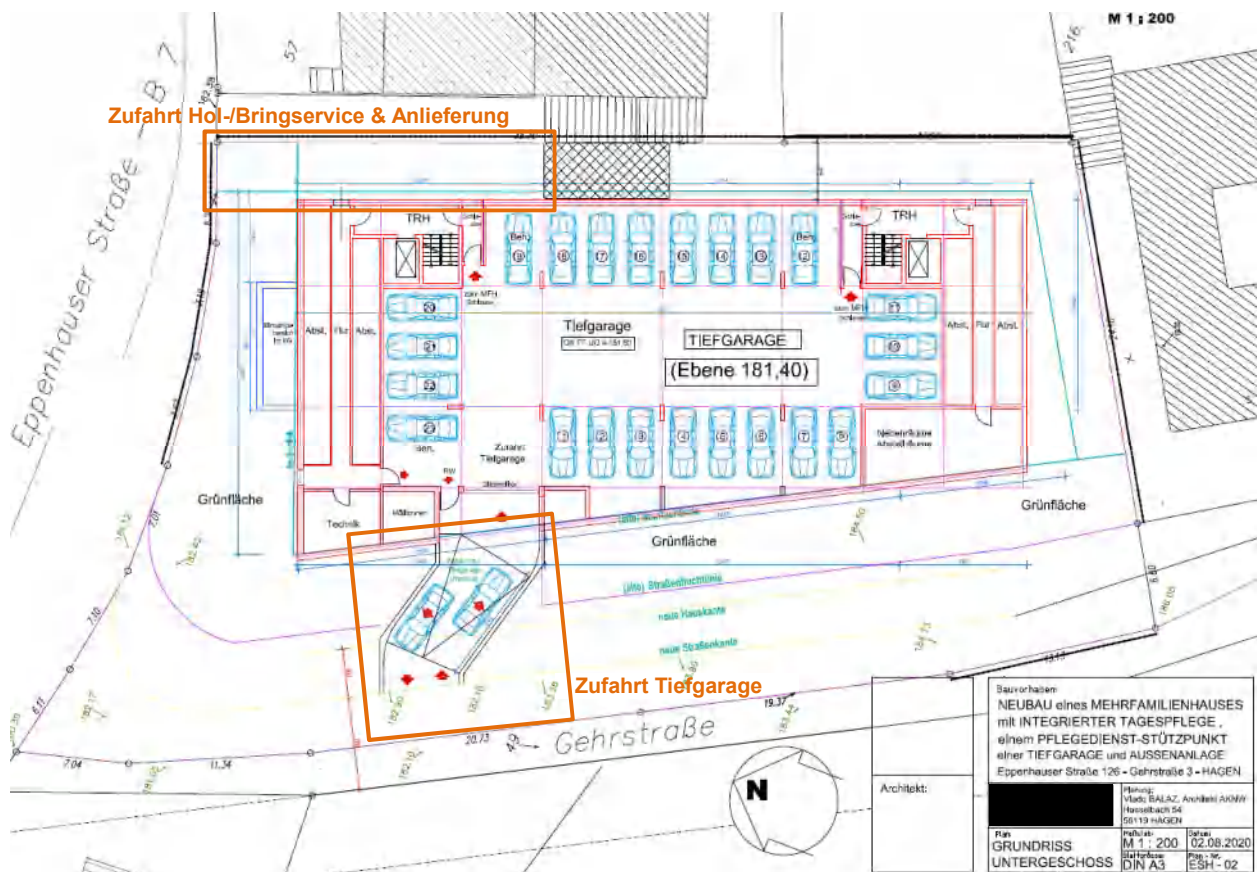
Geplante Erschließung des Plangrundstücks mit Zufahrt zur Tiefgarage über die Gehrstraße und Anlieferung über die Eppenhauser Straße; Grundlage aus [3]
